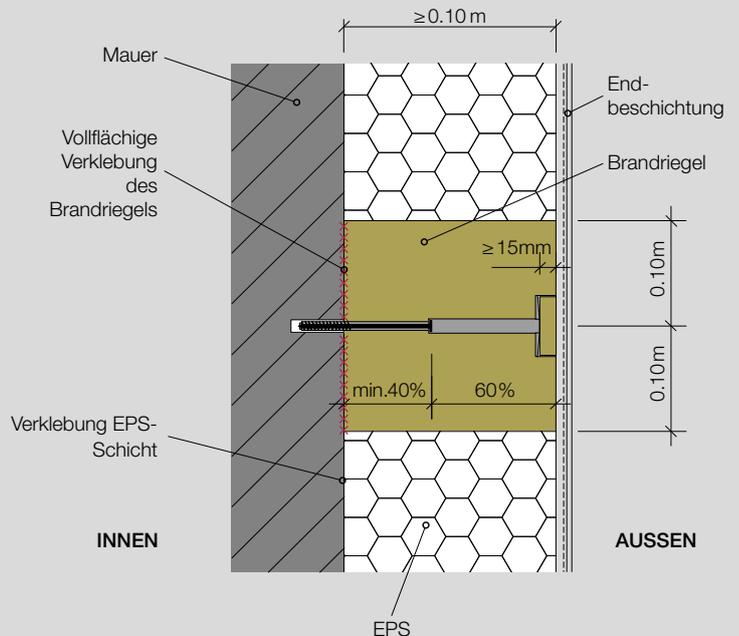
Detailbeispiel, mechanische Befestigung und Verklebung des Brandriegels
